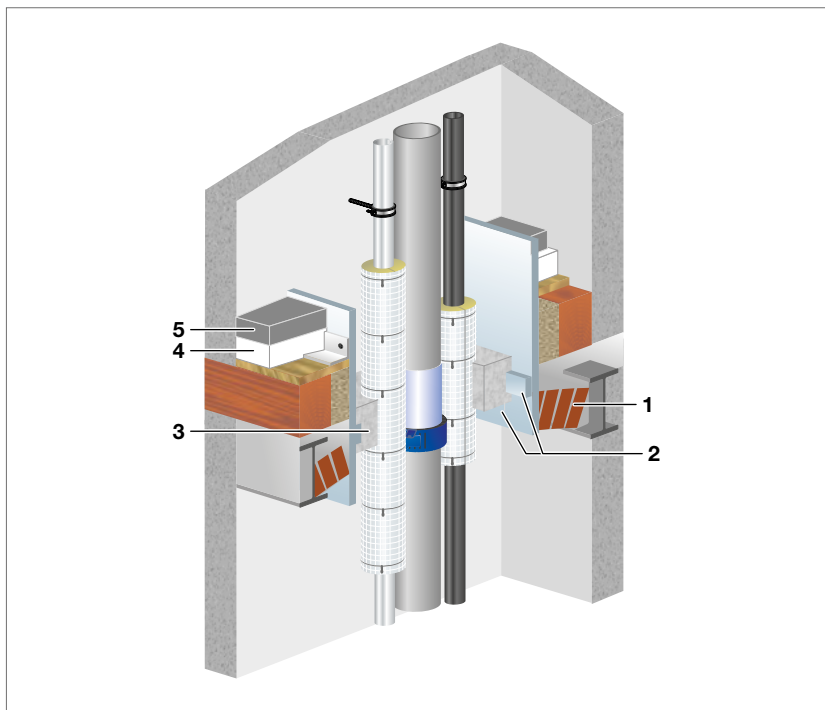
Gewölbedecke mit Mörtelverguss – „F 30-, F 60-, F 90“-Konstruktion
